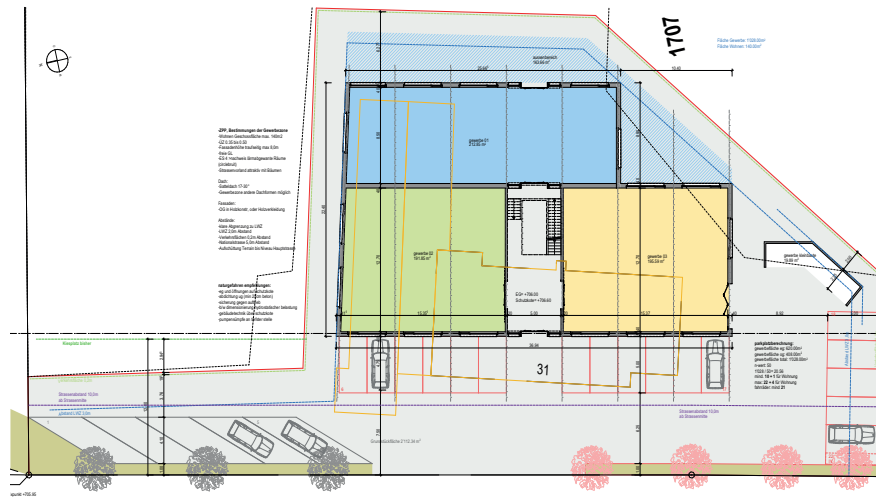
Situation mit Erdgeschoss zvg jfb architekten
